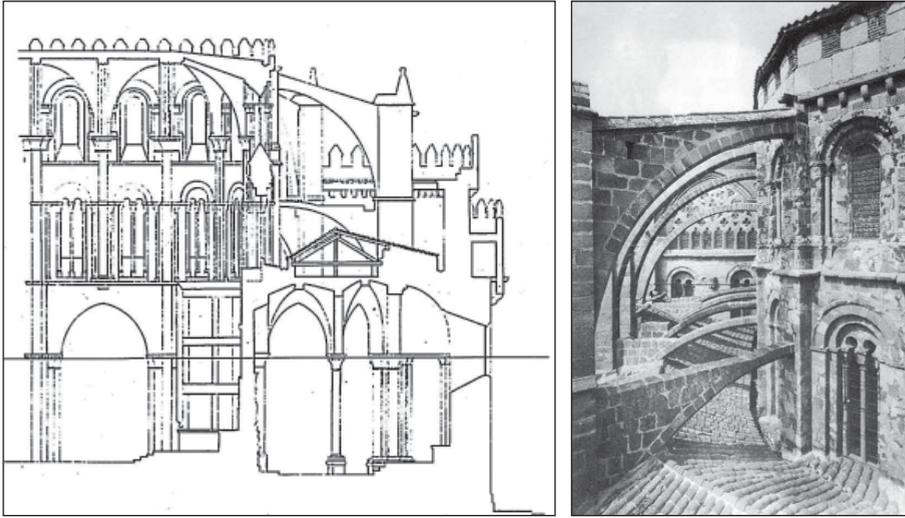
Detalle constructivo de la cubierta a dos aguas del cimorro, realizado por Pedro Feduchi y vista de la cubierta previa a la última intervención (Gómez-Moreno, 1900).
